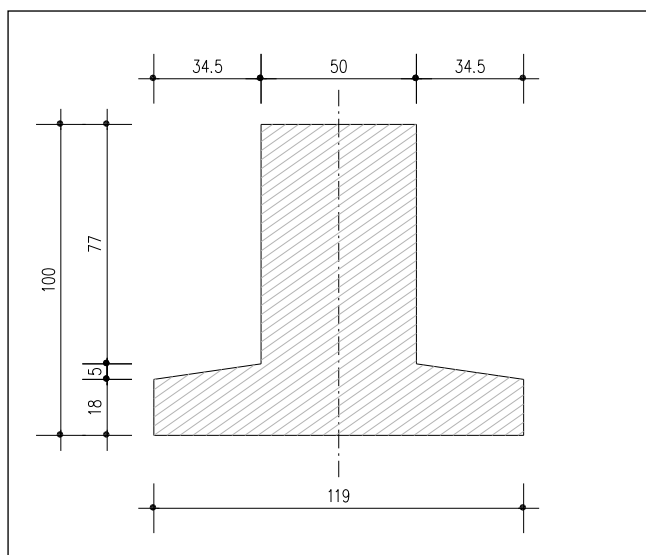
Sezione tipica trave prefabbricata in fase "1".
